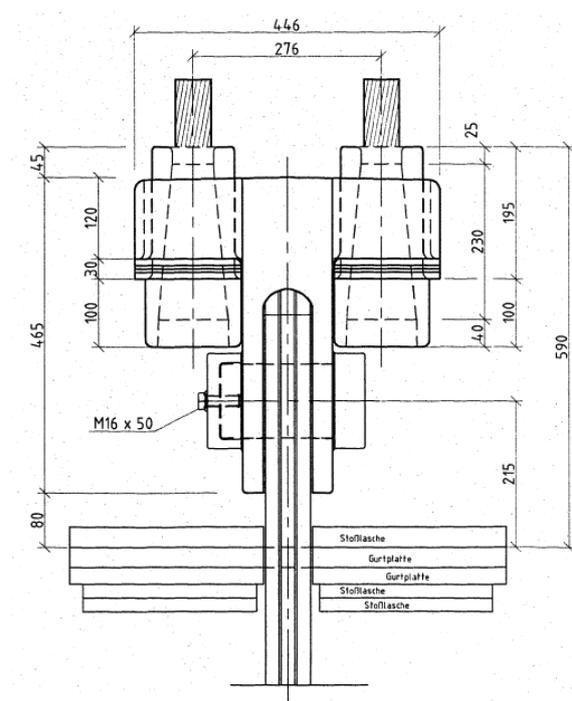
Detail Hängeranschluss an VT, aus Plan 5/805-02; Ansicht VT C
